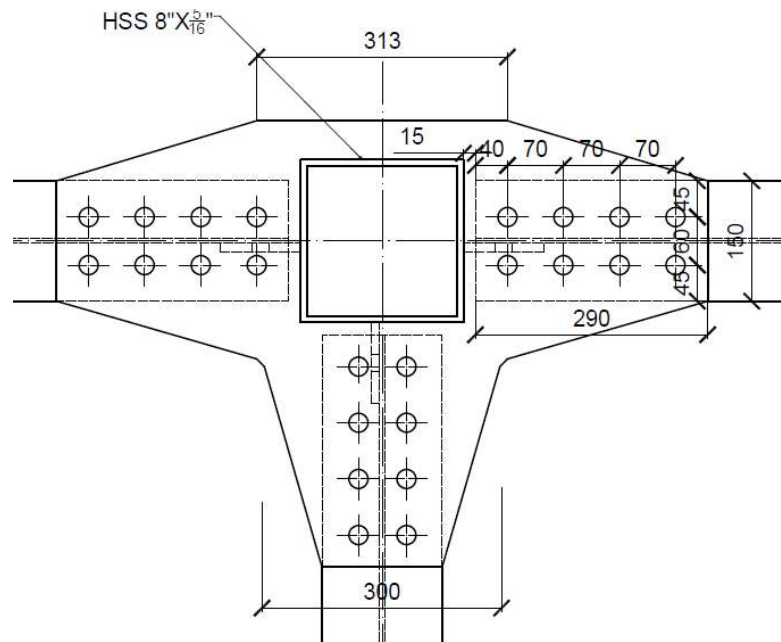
13- Vista superior de conexión viga-columna edificio P₁,L₁,Z₂.
